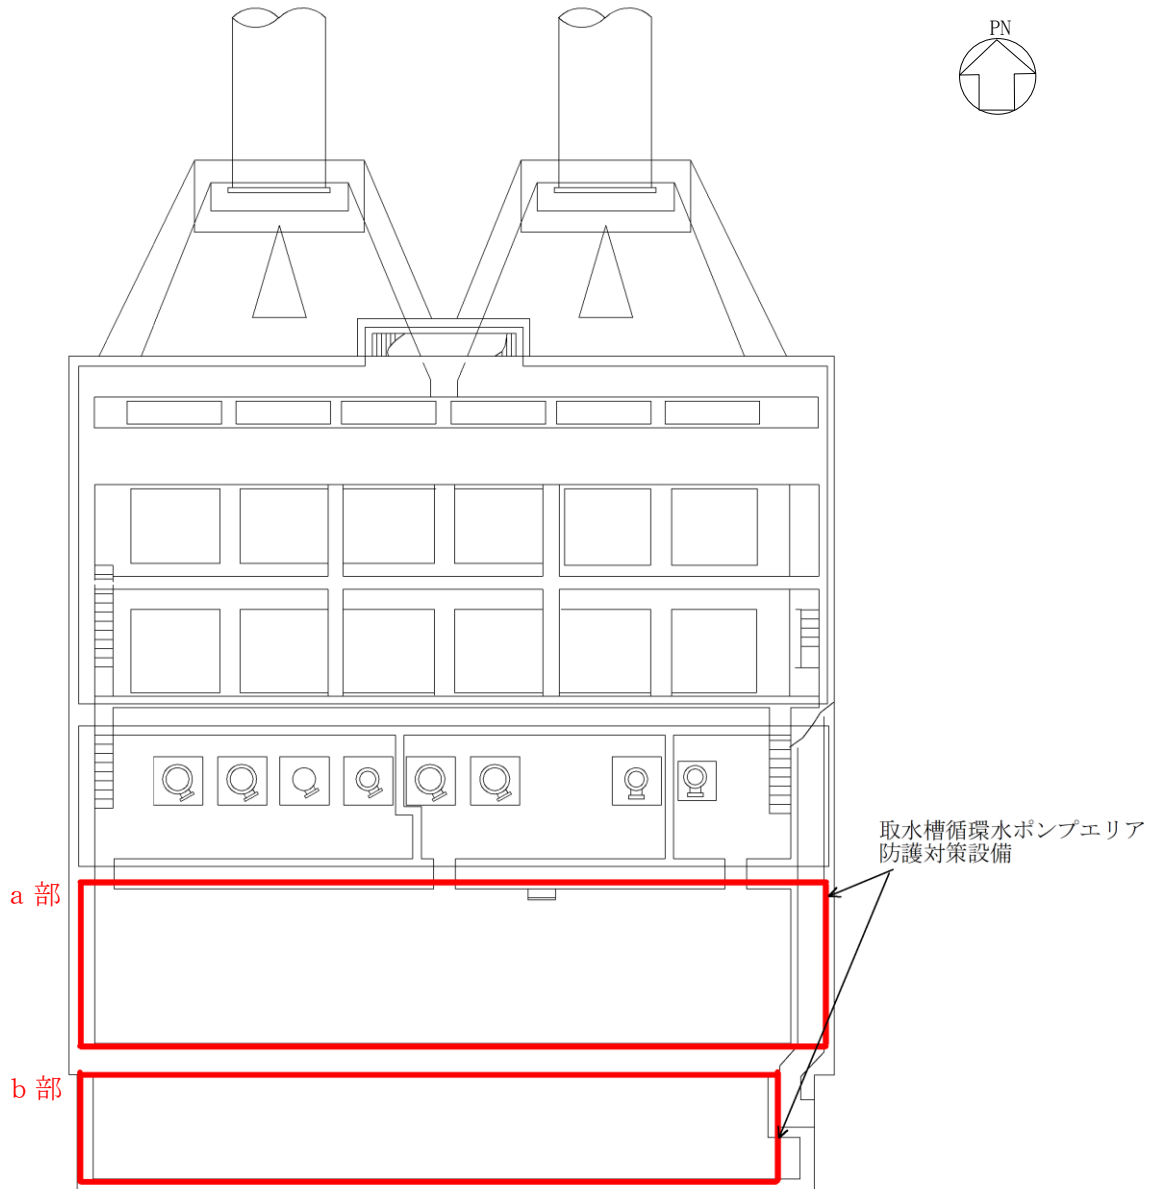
(1) 取水槽循環水ポンプエリア防護対策設備 平面図
